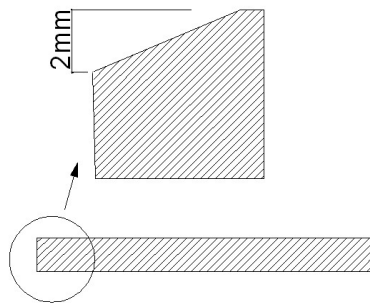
Tolérances dimensionnelles pour une dalle support d'une construction bois
